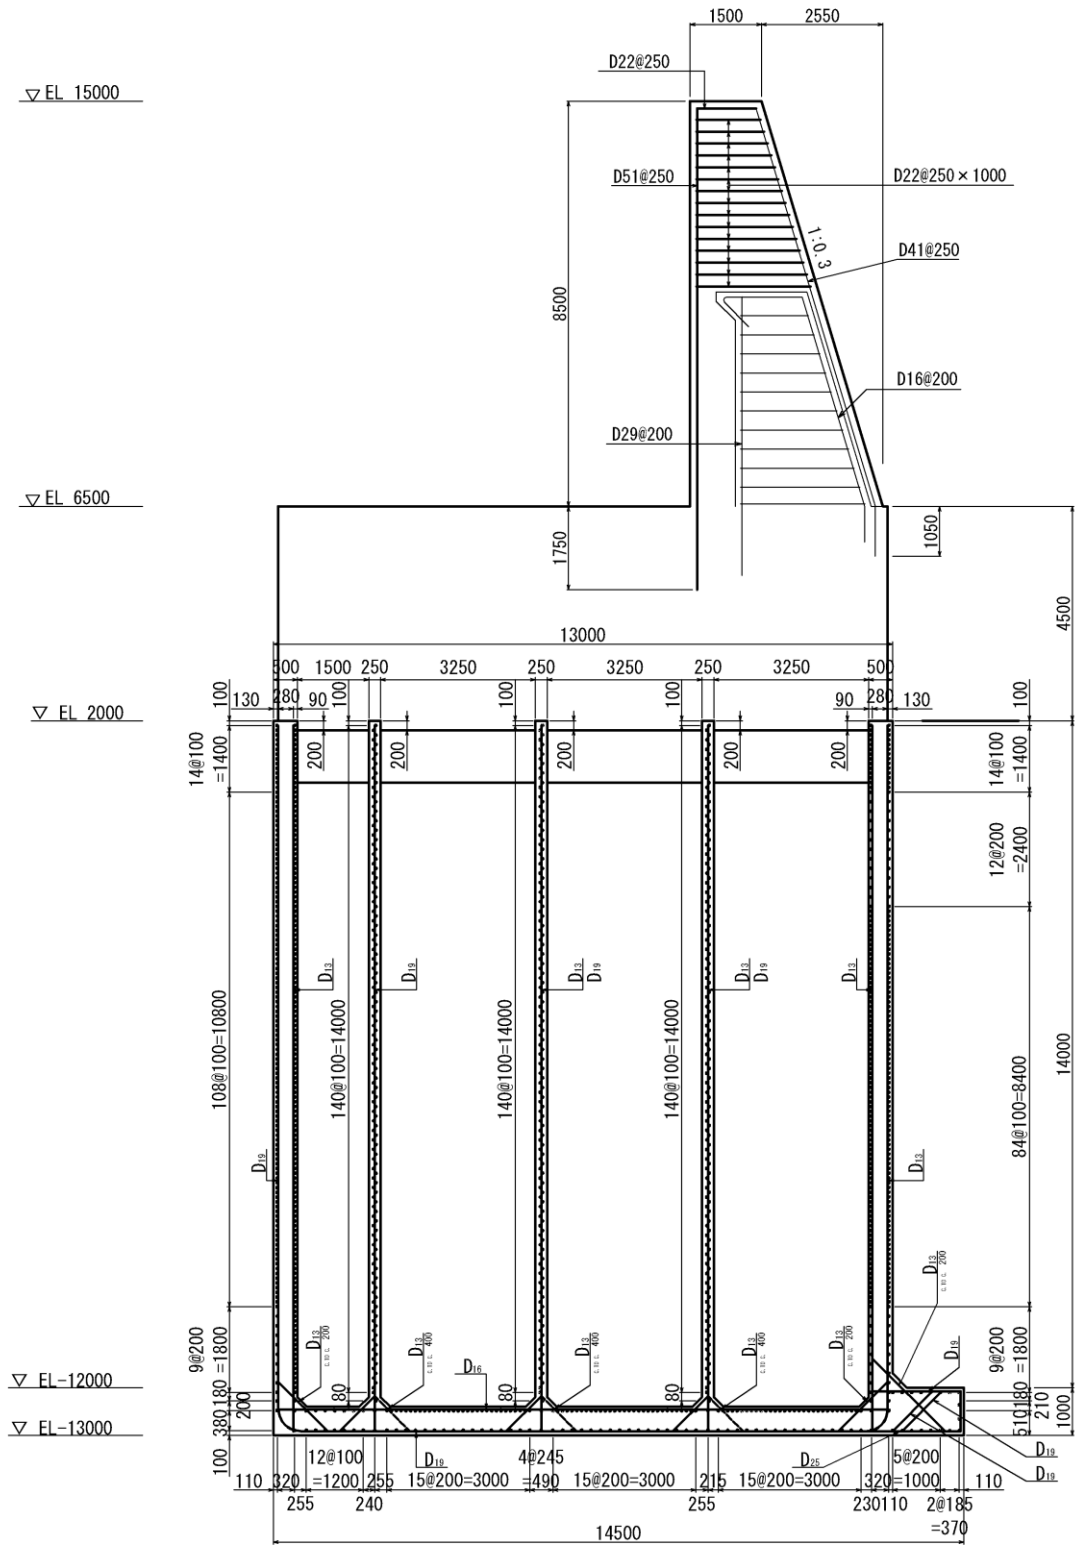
防波壁（波返重力擁壁）の概略配筋図（②-②断面）
